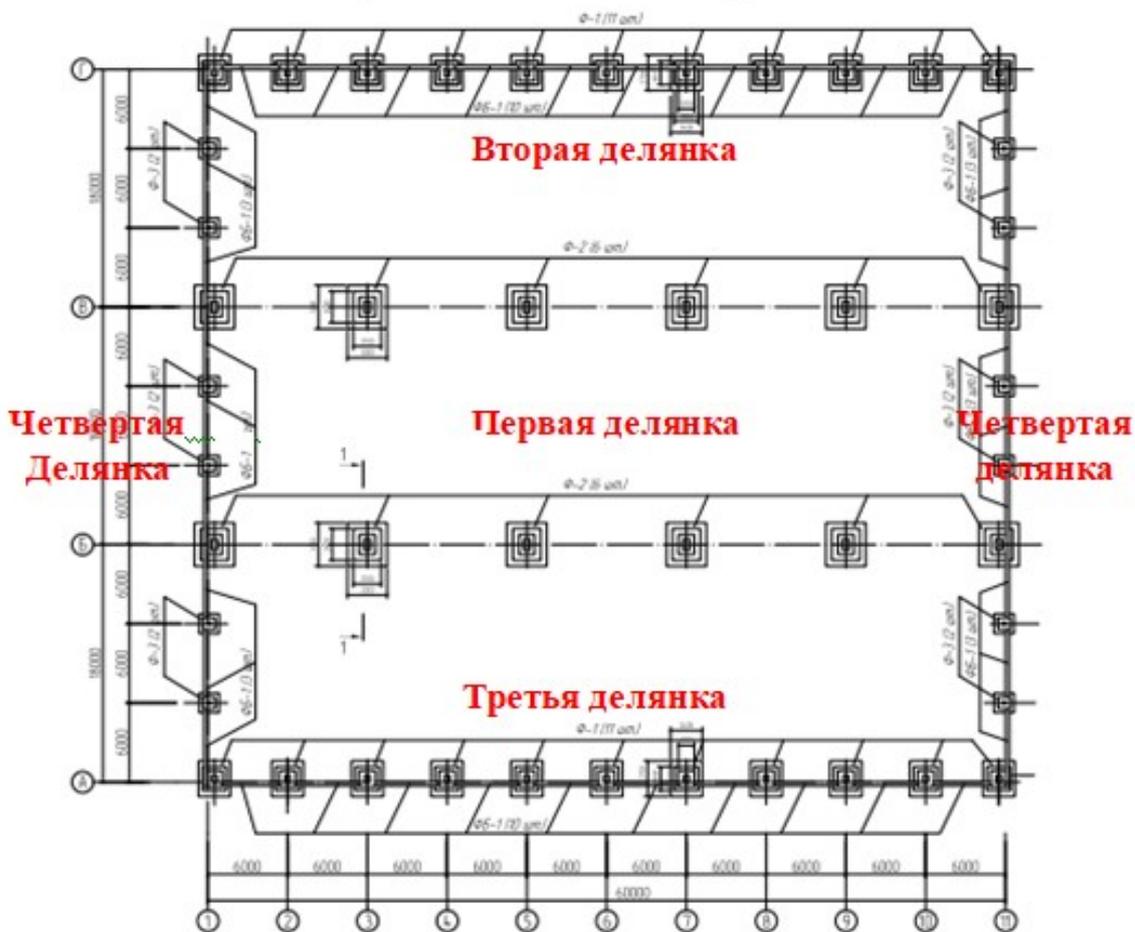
Разрез здания в осях А-Г и план фундаментов
